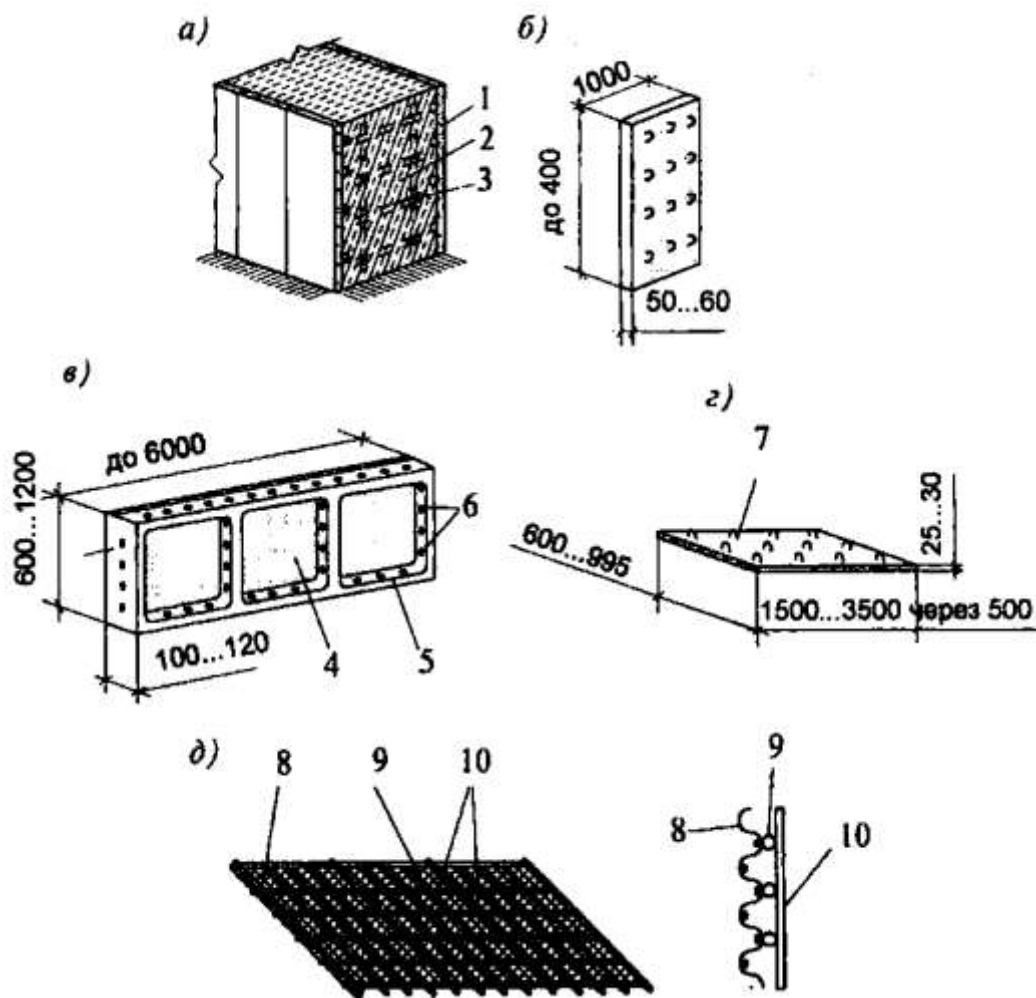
Опалубка - лицьовка (конструктивна опалубка):
